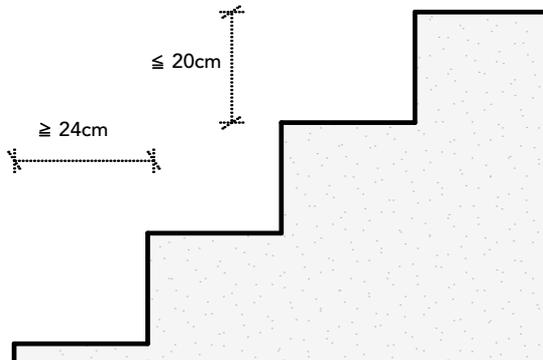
Treppensteigung Vergleich Japan/Österreich
